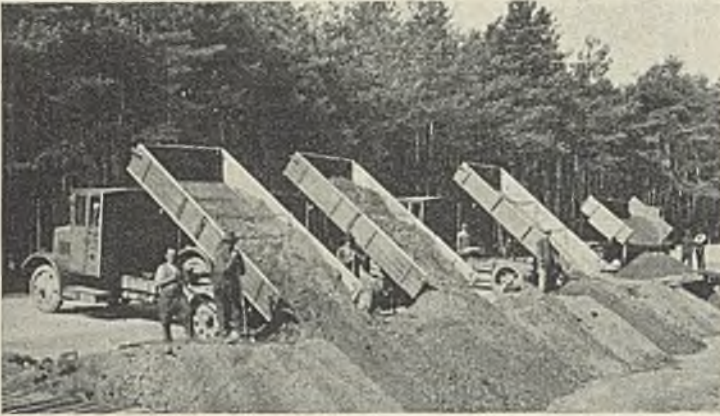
Vier Stück 5-t-Hinter- und Seitenkipper beim Entladen. M. A. N., Nürnberg.
